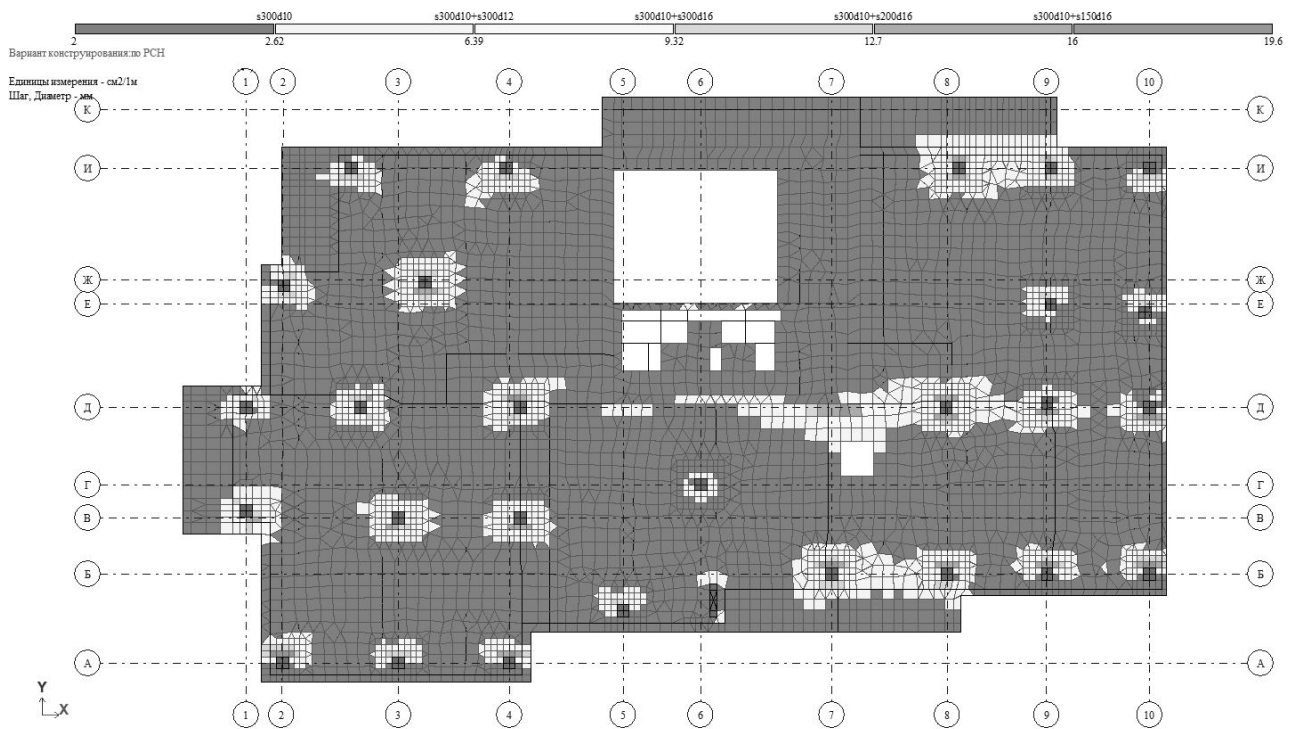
Требуемая площадь верхней арматуры вдоль Y
